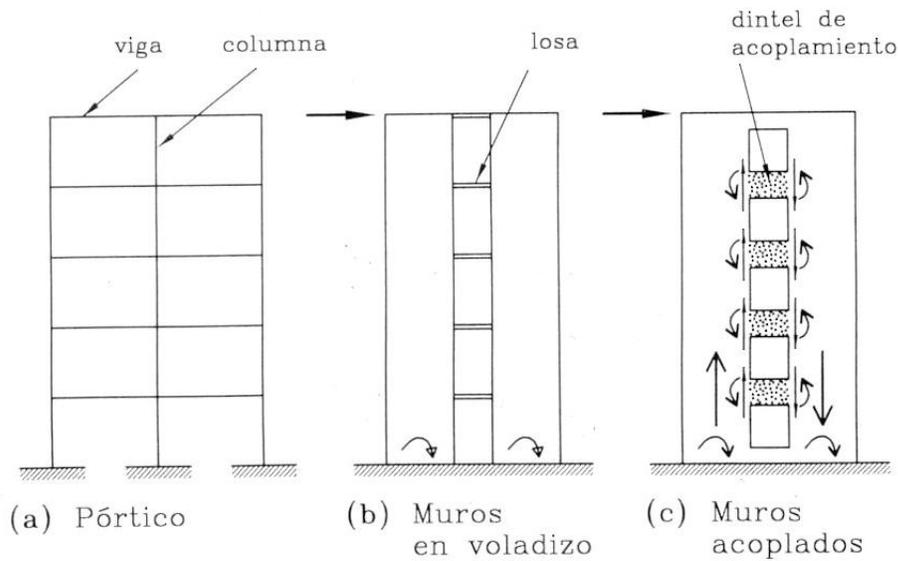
Tipos de estructuraciones aptas para resistir cargas horizontales.
